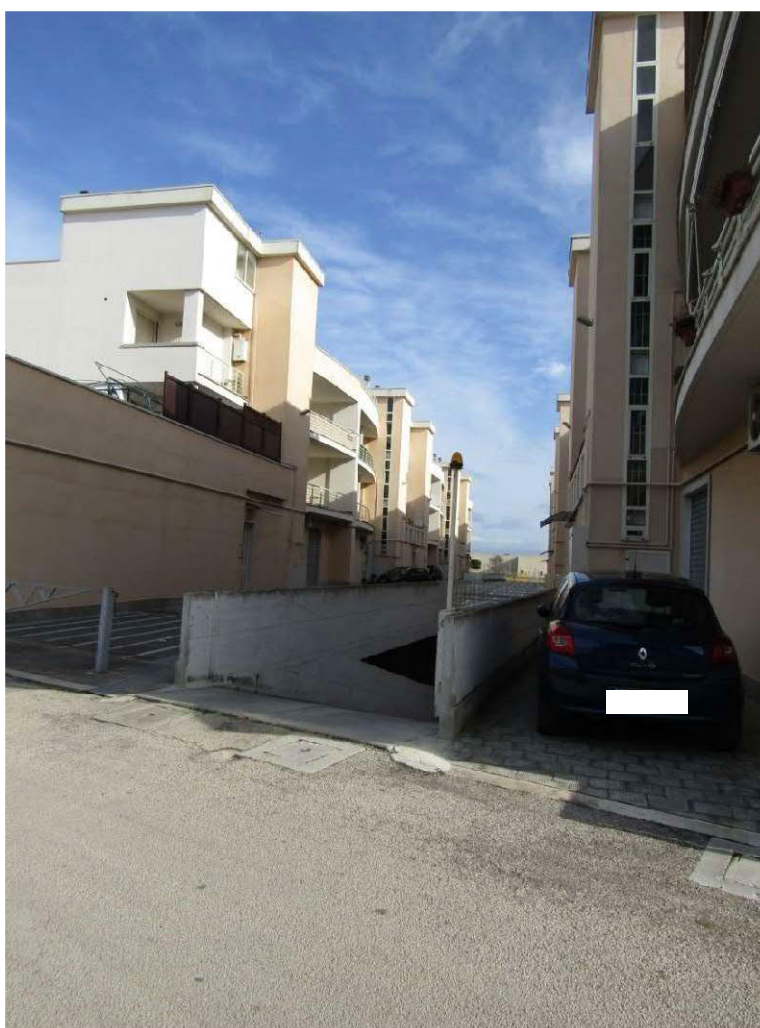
LOTTO 9 – BOX AUTO IN FOGGIA – FABBRICATO B – RAMPA DI ACCESSO AI BOX INTERRATI
